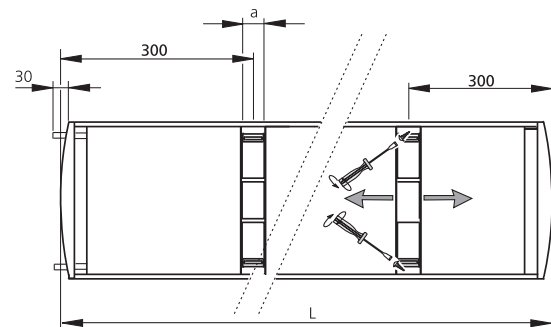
Horizontaler Anschluss im Endstück -H, Draufsicht.
